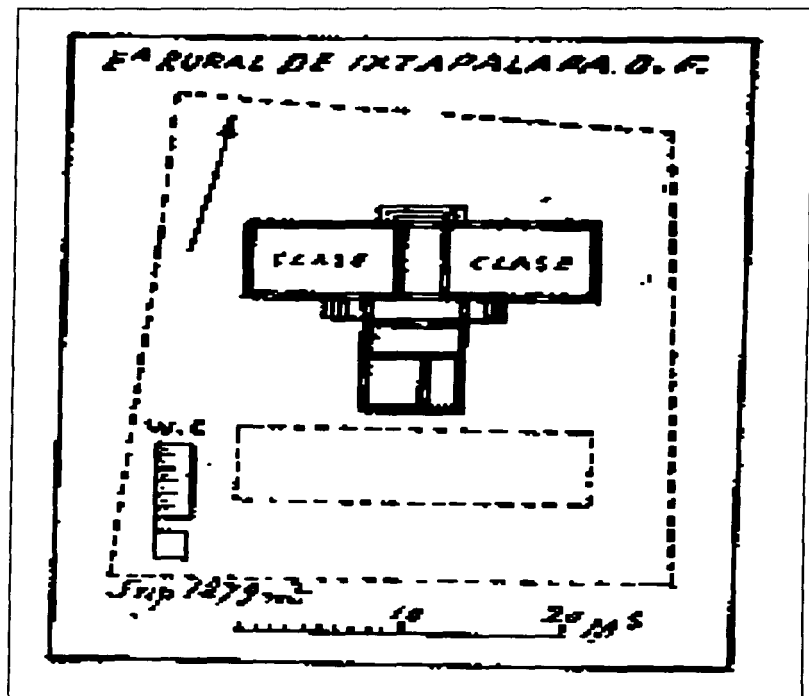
(06) Aula casa rural en Ixtapalapa.
